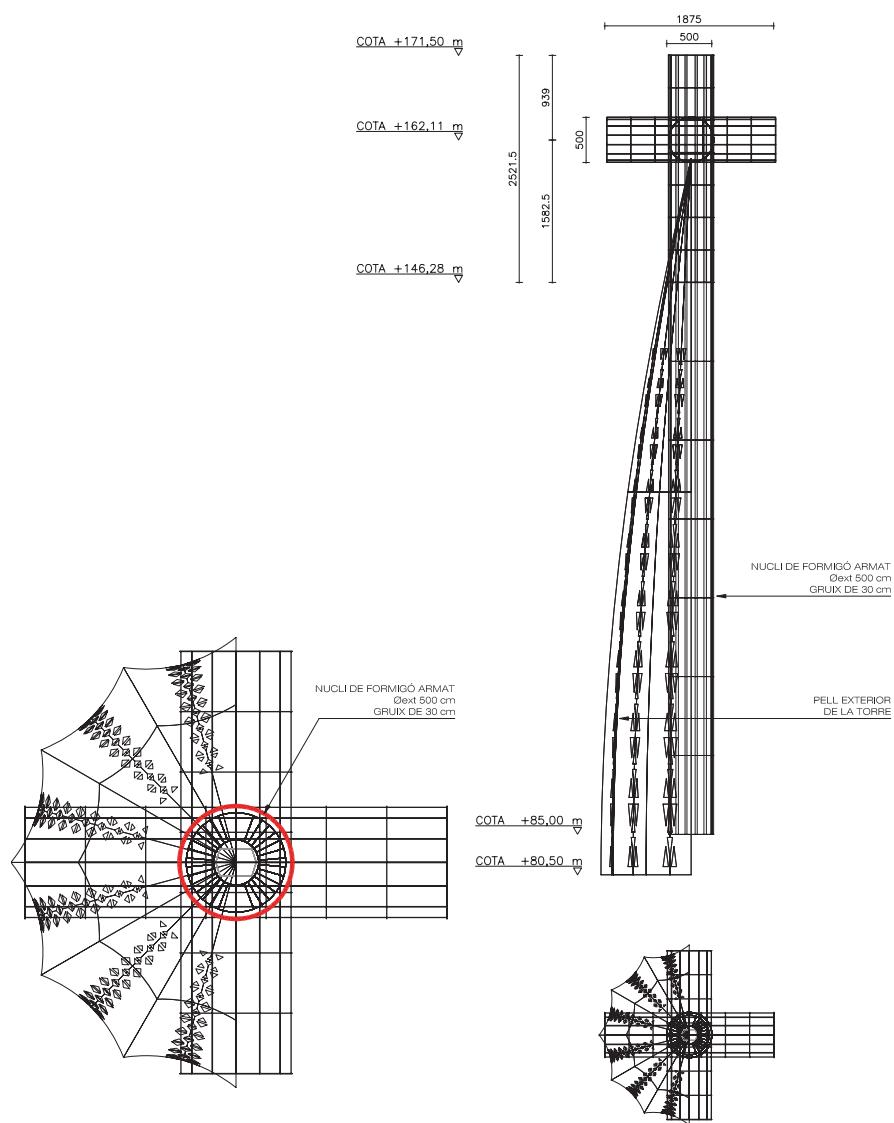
Planta y alzado de la Cruz de la Torre de Jesucristo.
